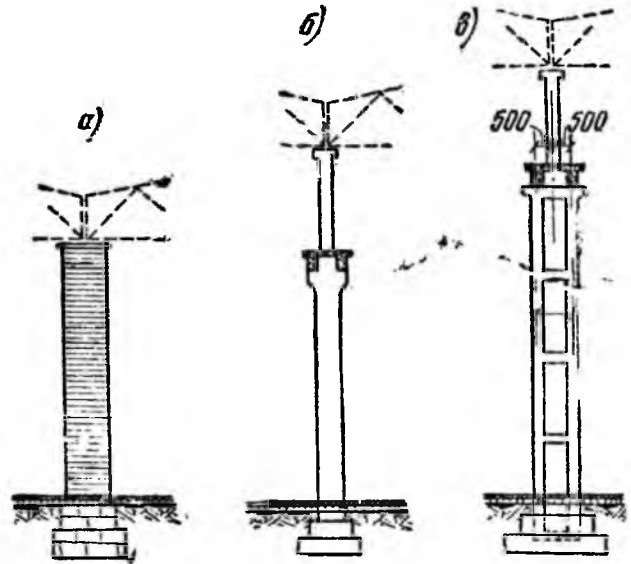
Внутренние кирпичные столбы и железобетонные колонны
